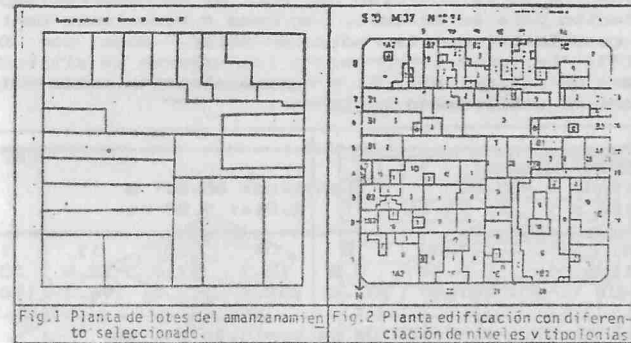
Planta de lotes del amanzanamiento seleccionado.
